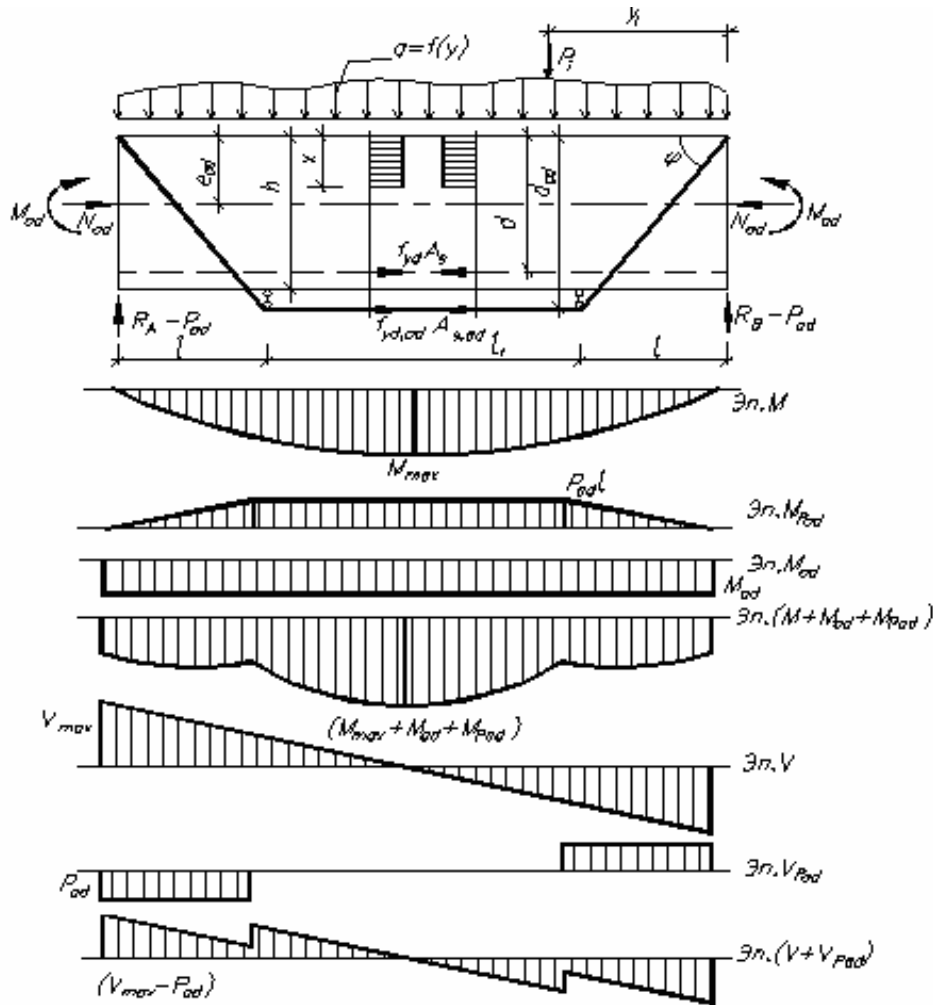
Расчетная схема изгибаемой конструкции, усиленной шпренгельной затяжкой
